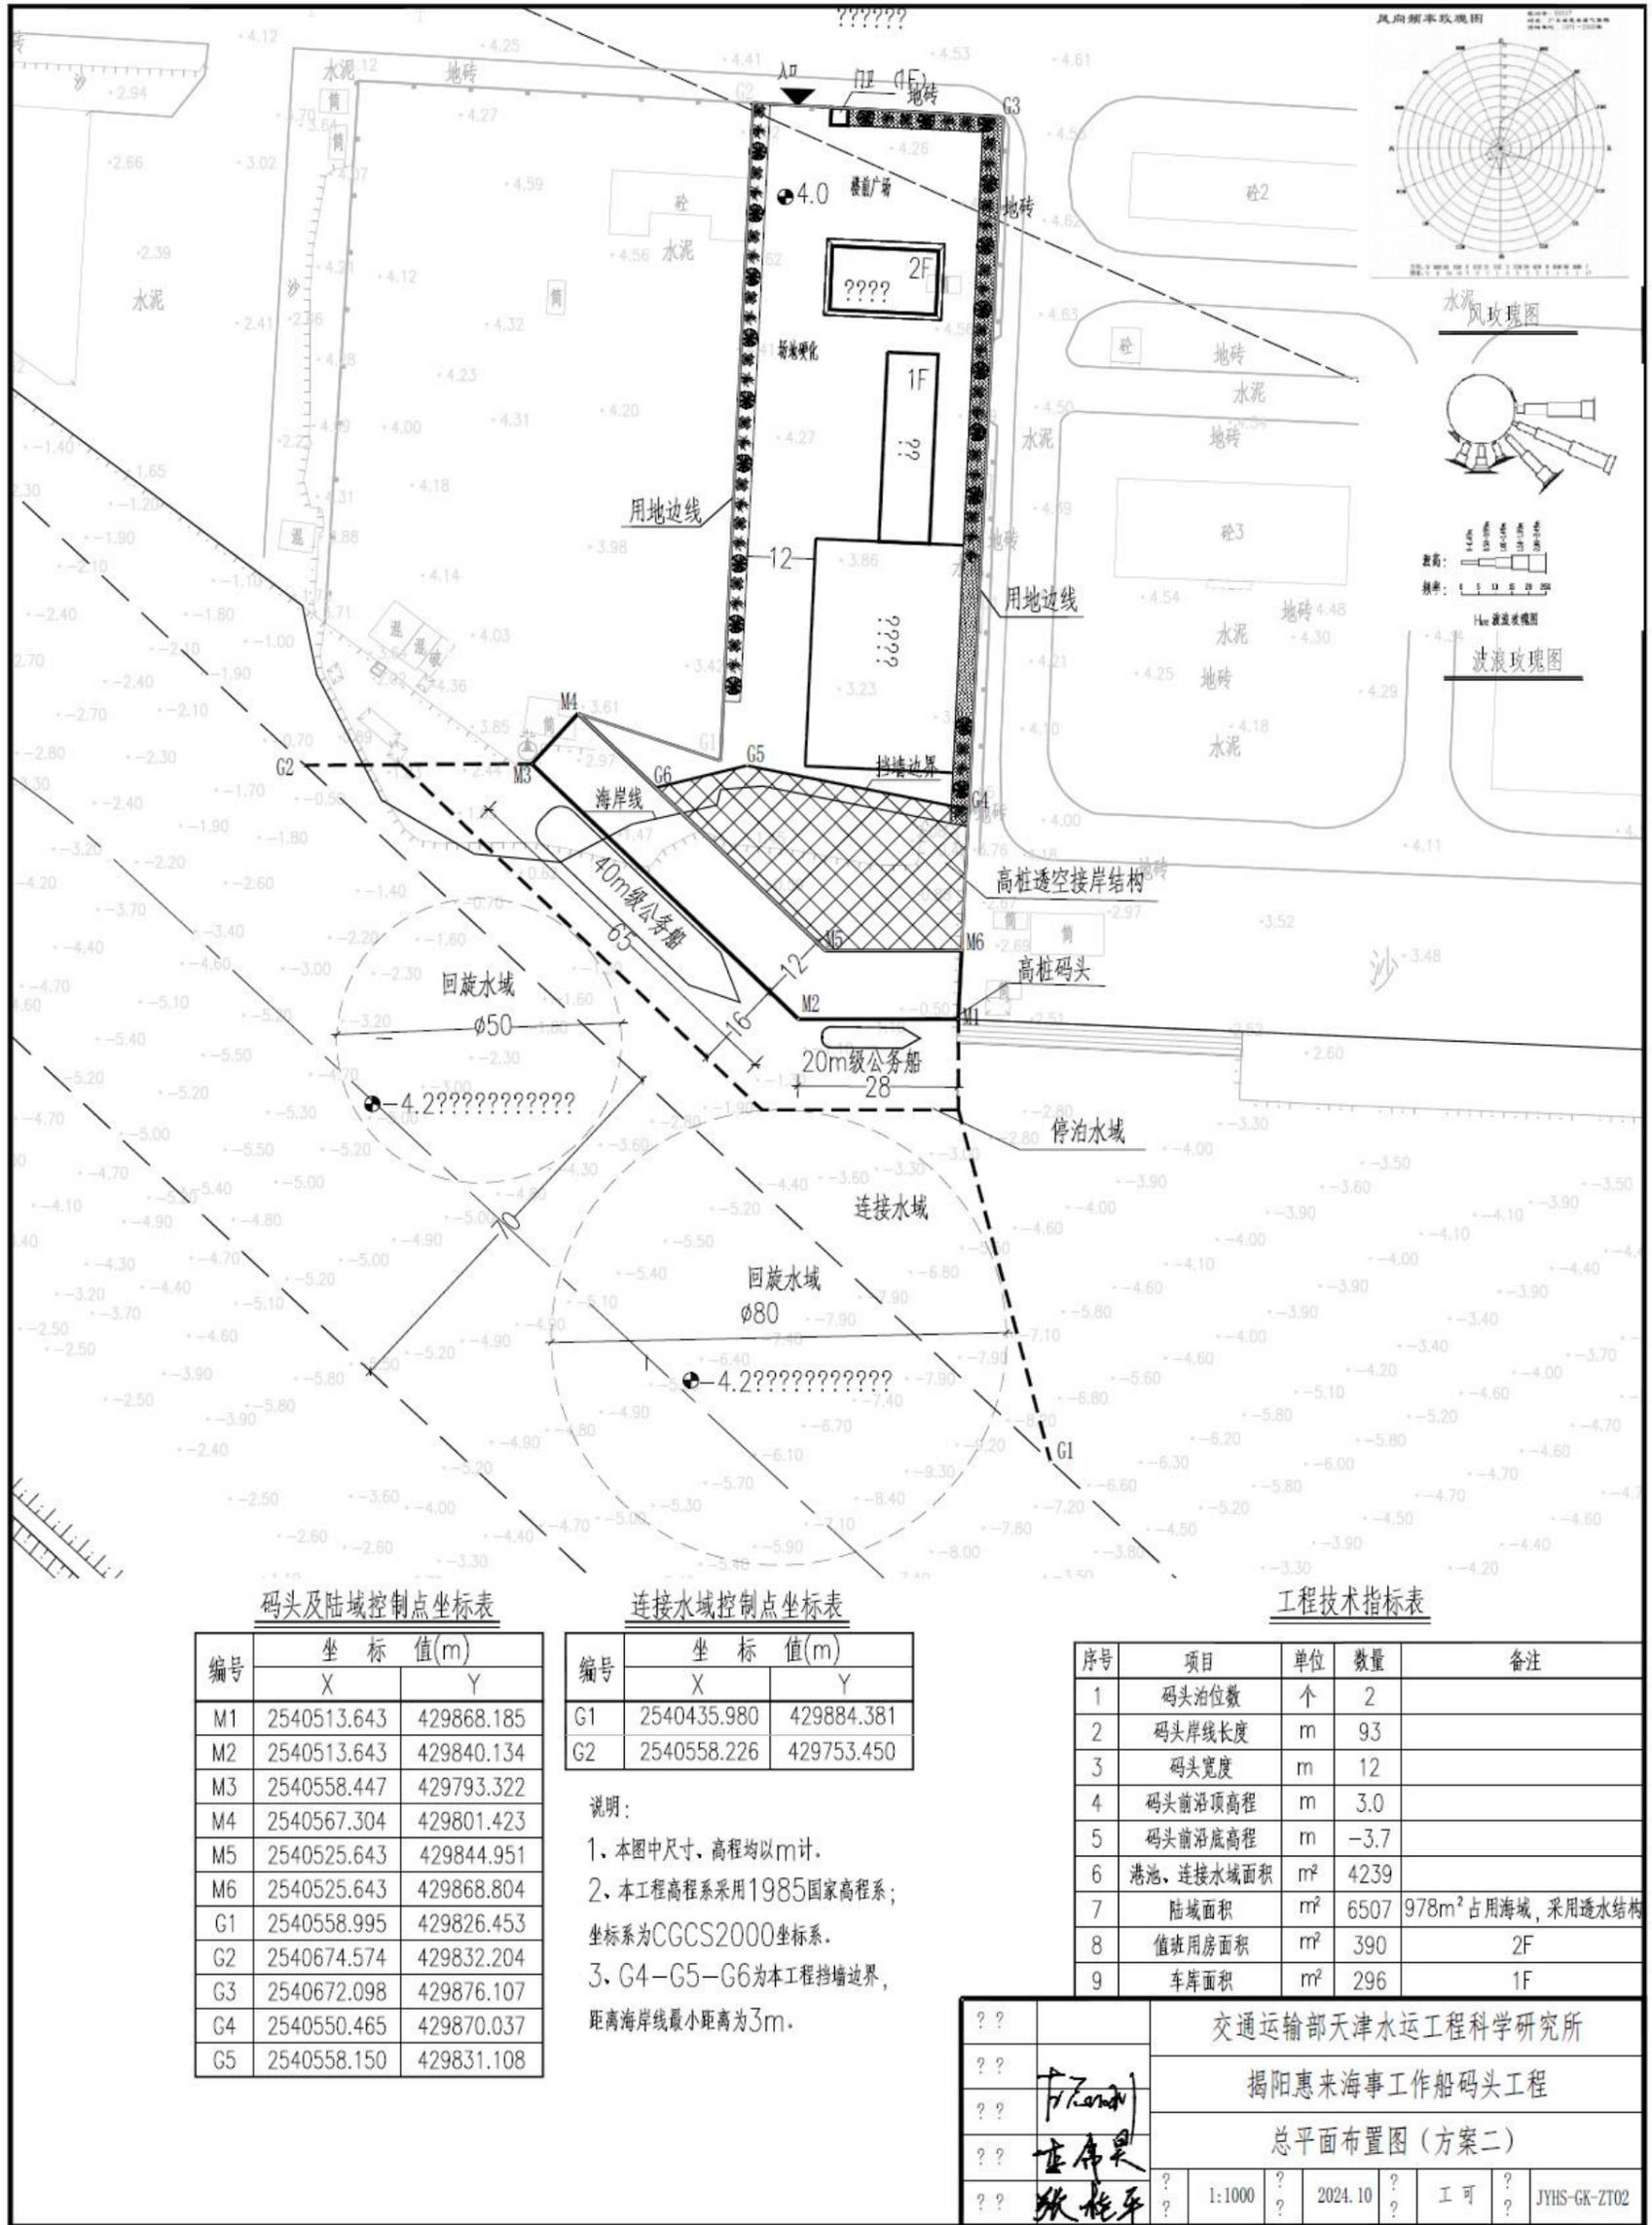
项目海域水深及平面布置图(方案二)
